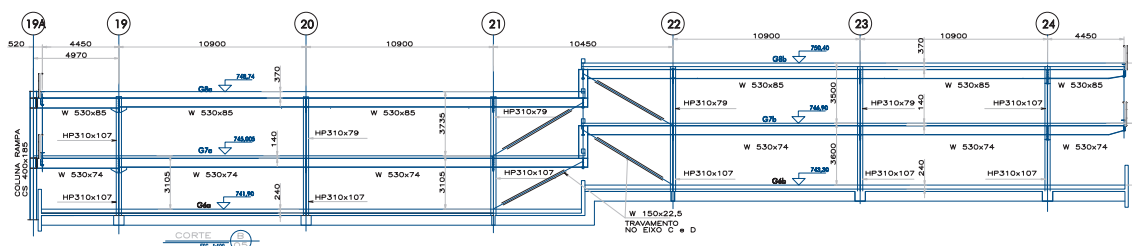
Sistema de estabilização da estrutura por contraventamentos
